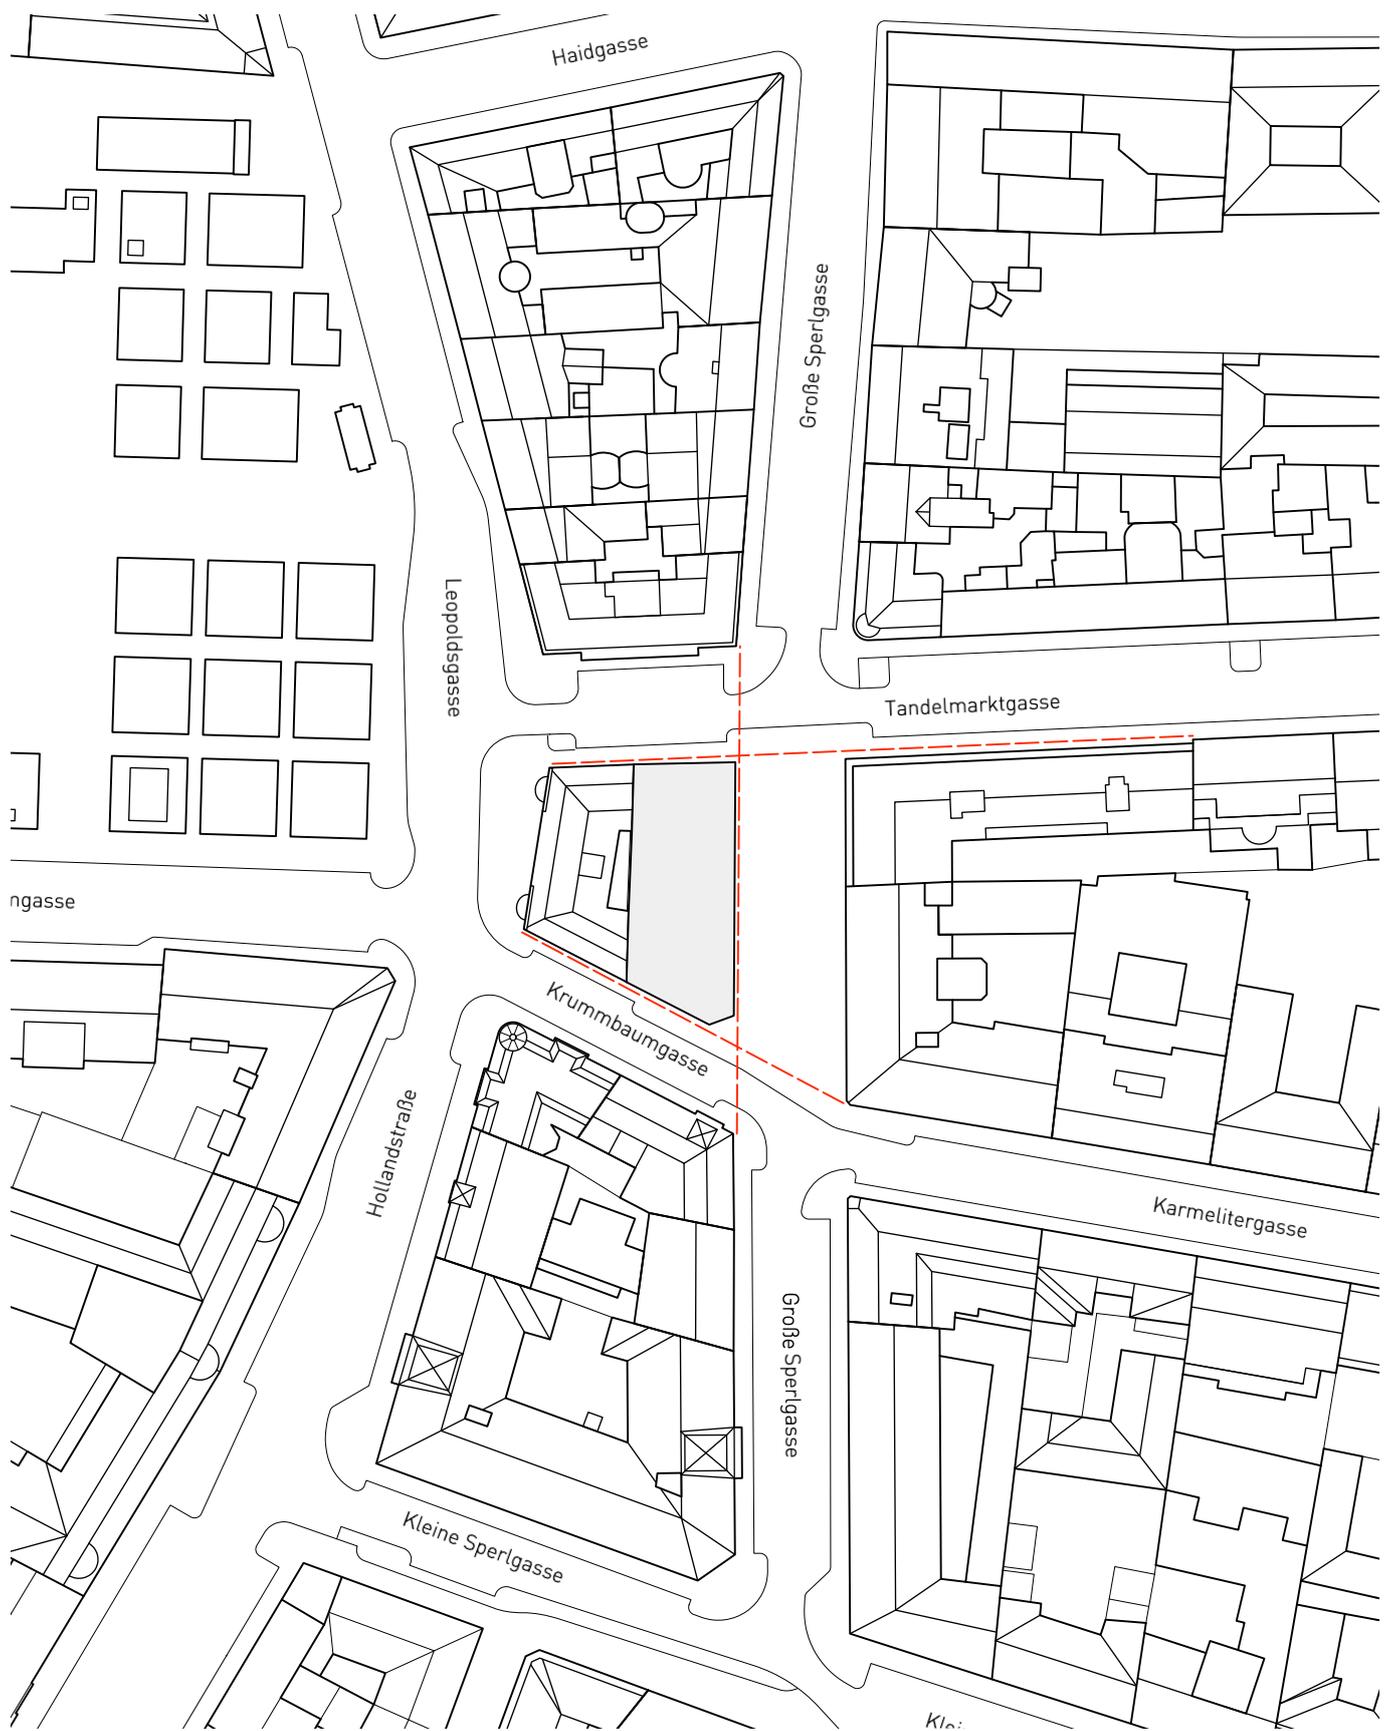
Lageplan mit ursprünglichem Grundstückszuschnitt 1:1000 (BM)
